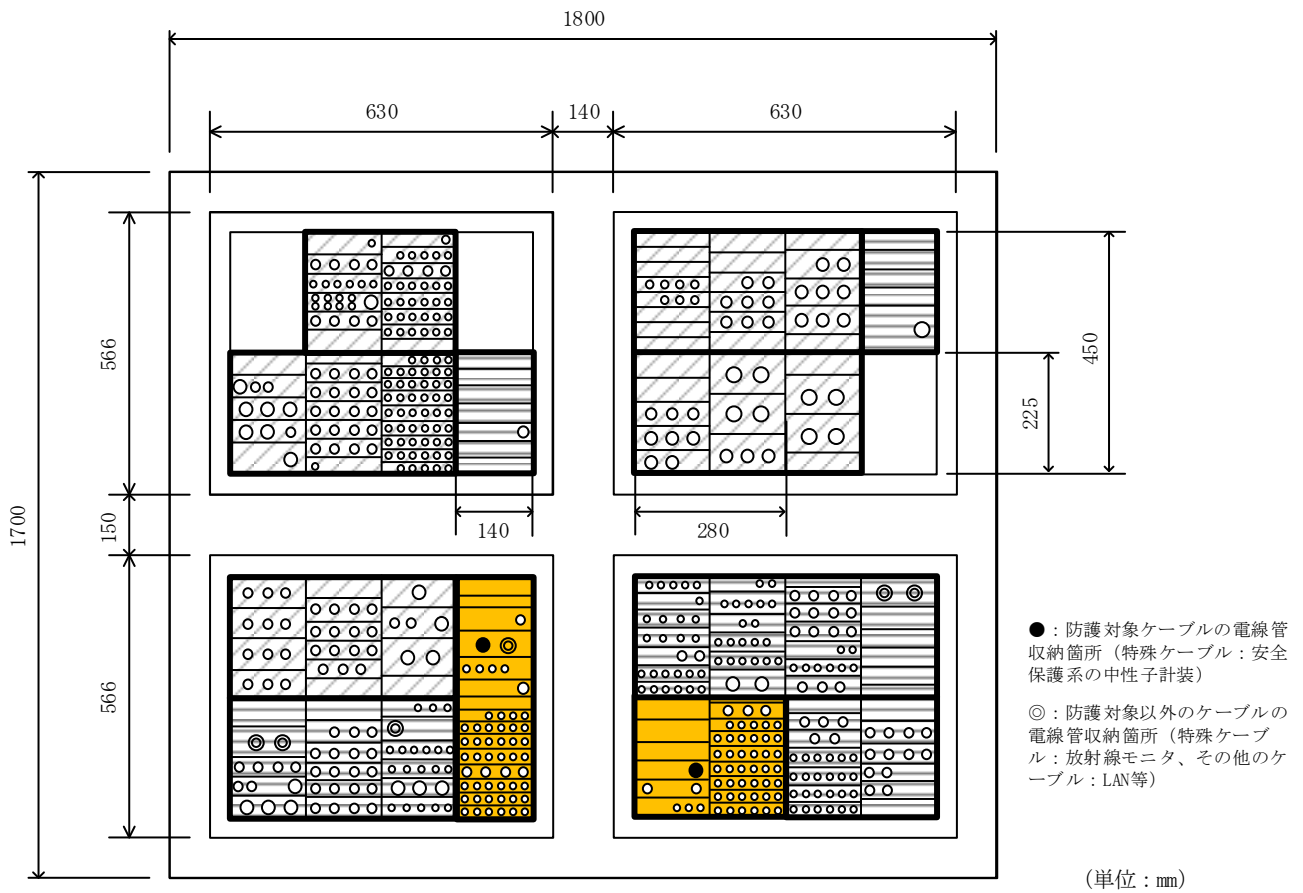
貫通部のケーブル詳細配置図 (原子炉建家側視点)
